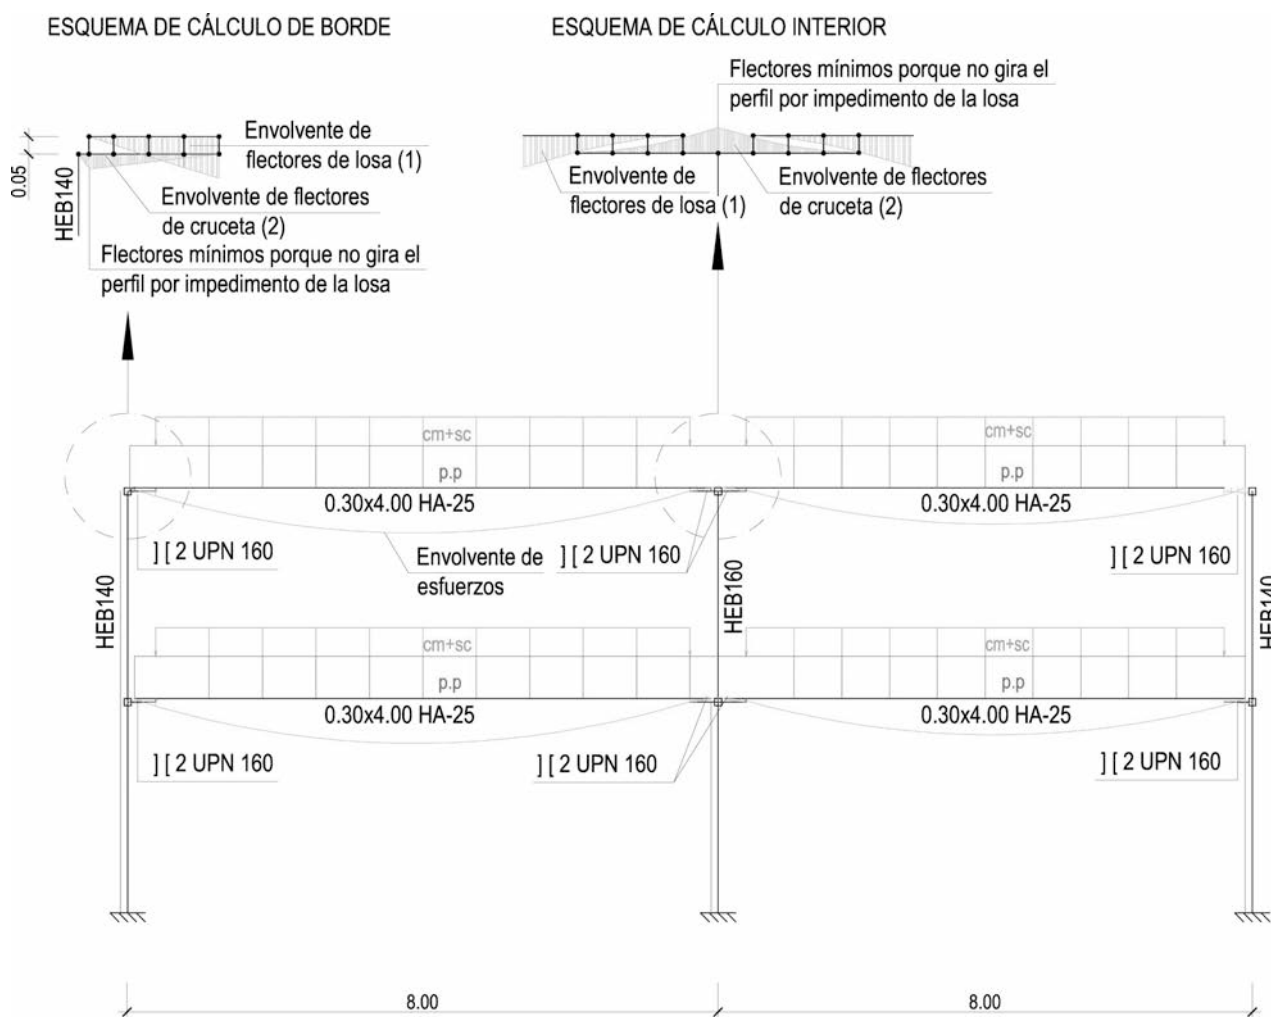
Esquema simplificado de cálculo y funcionamiento de crucetas embebidas en losa de hormigón
